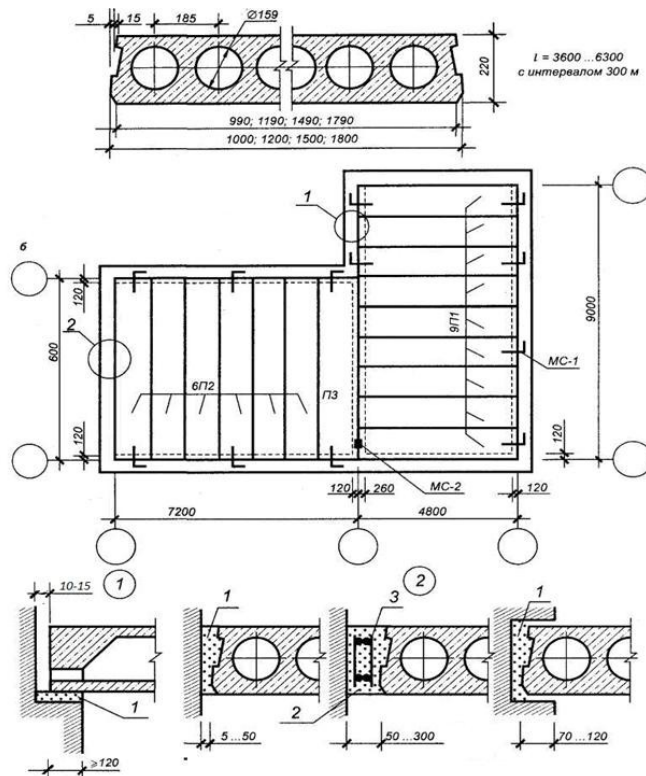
Плита перекрытия типа ПК, план перекрытия и детали опирания на стену и примыкания к ней:
